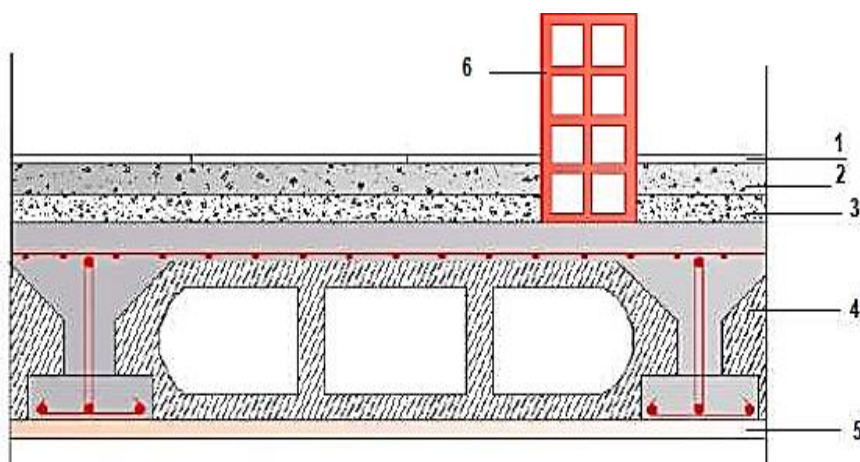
Coupe verticale d'un plancher à corps creux de niveau courant
